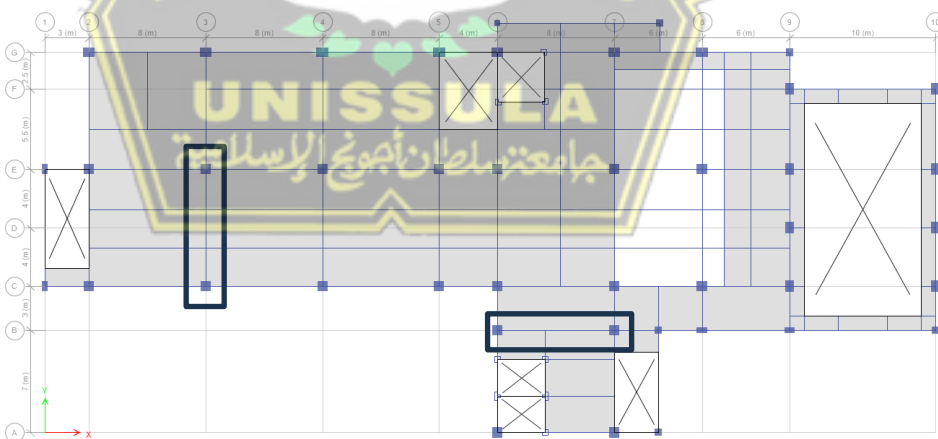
Lokasi Balok Lantai 2 yang di-Release
